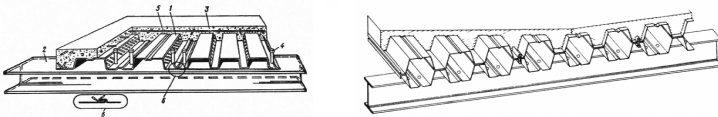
Монолитное комбинированное перекрытие с несъемной опалубкой: 1 – стальной профилированный настил; 2 – элемент балочной клетки; 3 – монолитный бетон перекрытия; 4 – стержневой анкер; 5 – сетка противосадоочного армирования; 6 – соединение гофрированных профилей в виде V-образного замка
